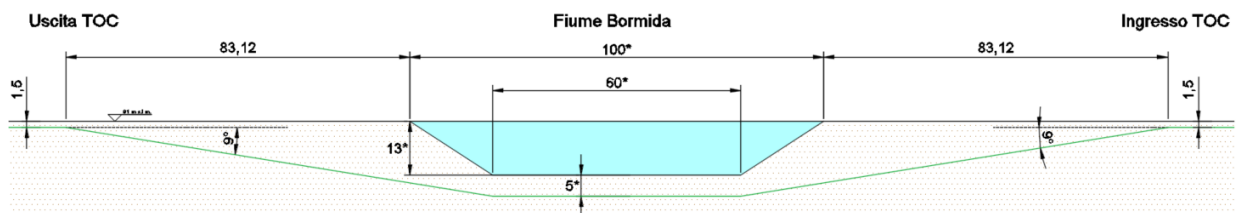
Profilo tipologico dell'attraversamento in subalveo (si veda elaborato "GRE.EEC.D.27.IT.P.13131.00.71_Planimetria interferenze opere di rete - Guarasca")
